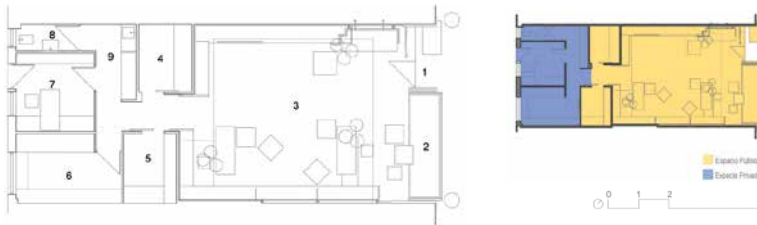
Planta tienda de Loewe, Londres. Elaboración propia.
